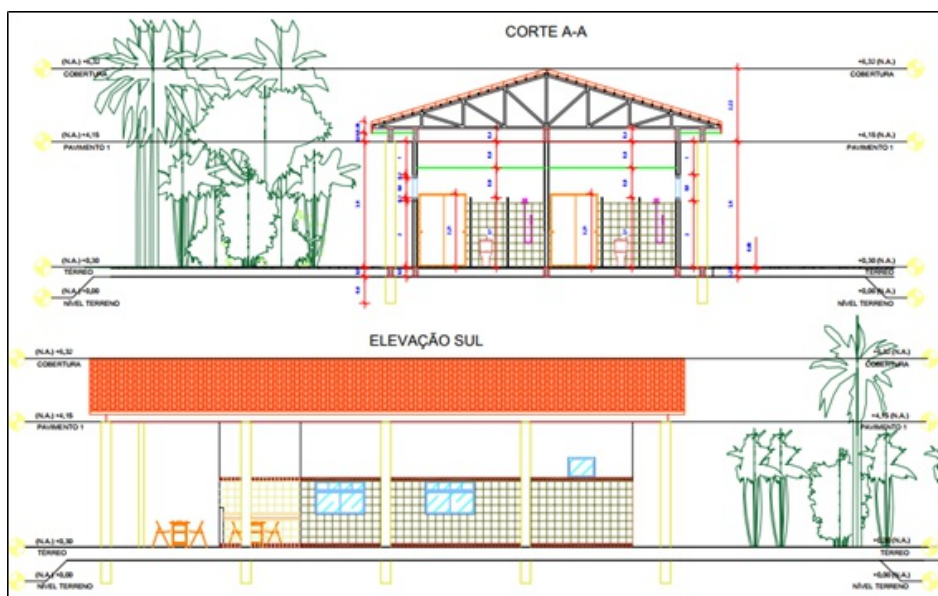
Corte transversal (Corte A) e Fachada frontal (elevação Sul) da Oficina e Depósito Coordenação de Infraestrutura e Logística.
